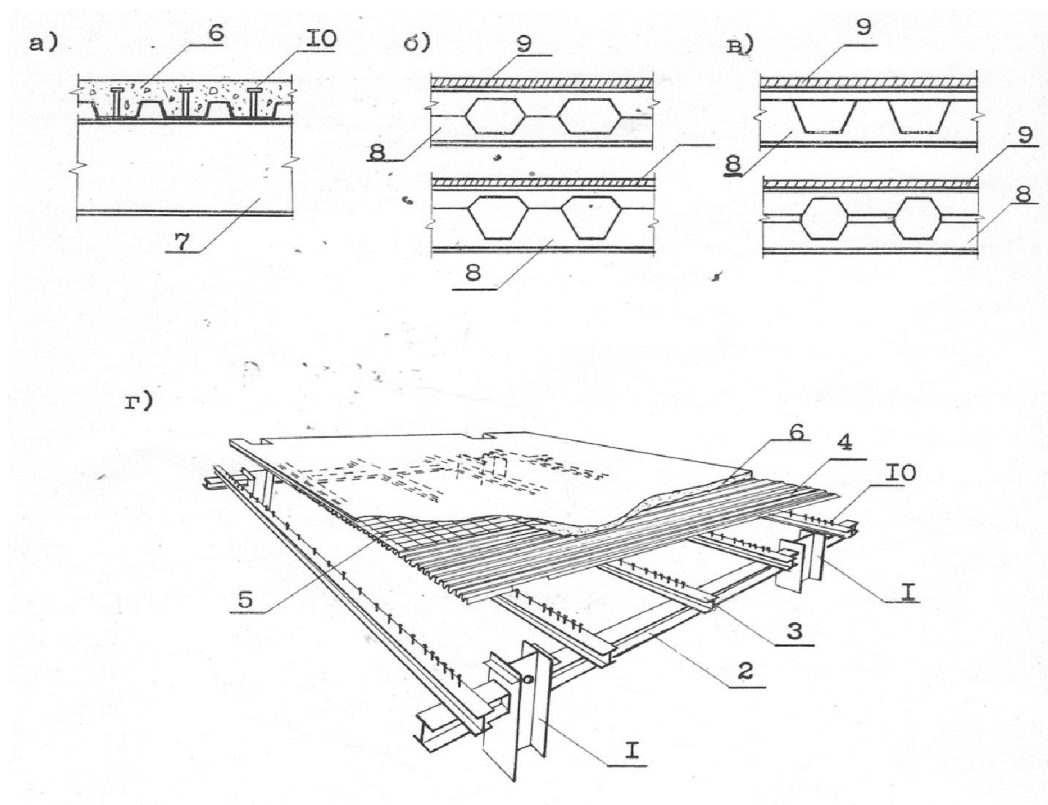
Комбинированное перекрытие, выполненное по стальным балкам.
